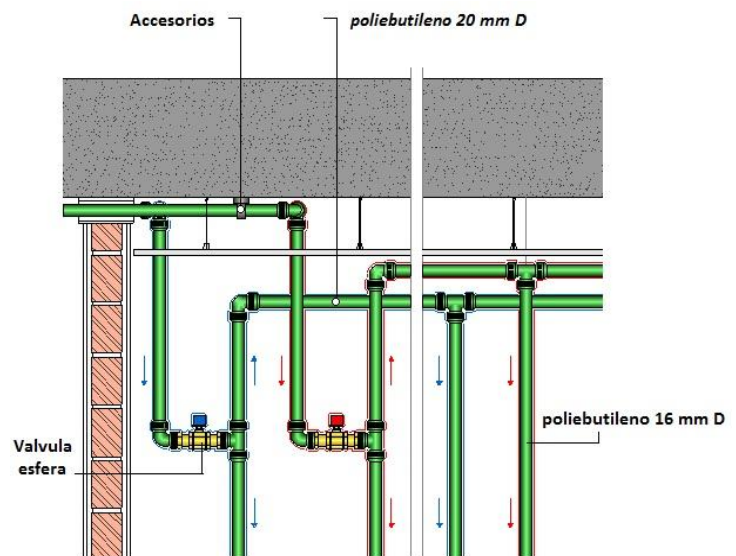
Detalle Fontanería y llaves de corte 2016, CYPE
